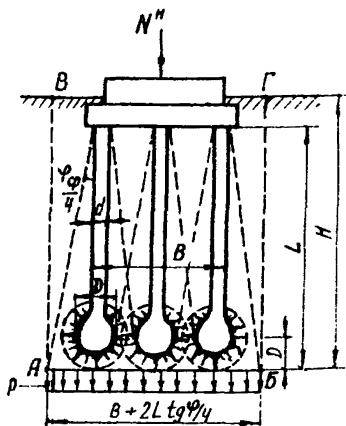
Схема к расчету осадок условного фундамента при кустовом расположении свай с уширенной пятой, образуемой методом камуфлетирования/взрывом/ или трамбования.
